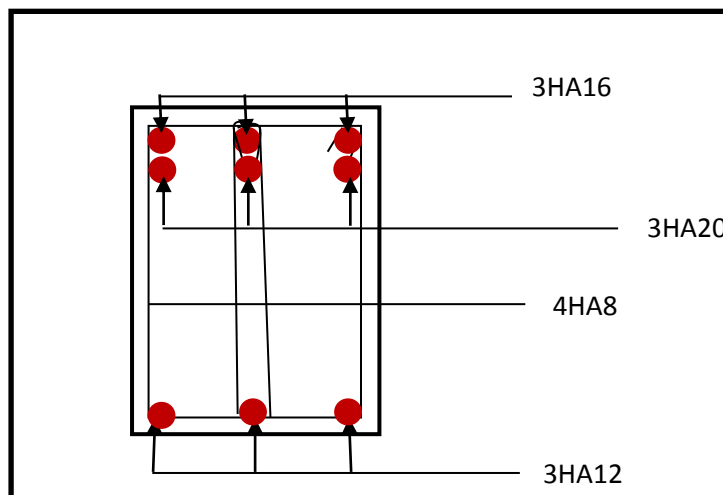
Ferraillage sur appuis d'une poutre principale.
